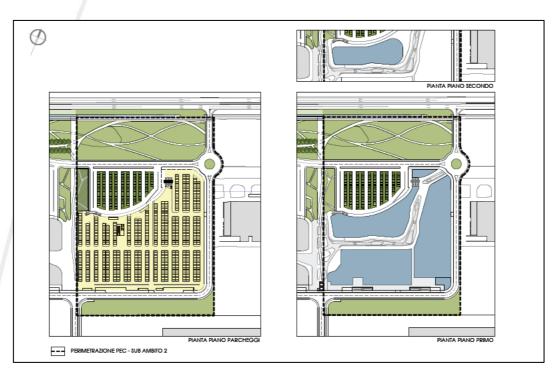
Tipologie edilizie indicative – Pianta piano parcheggi, piano primo e piano secondo
